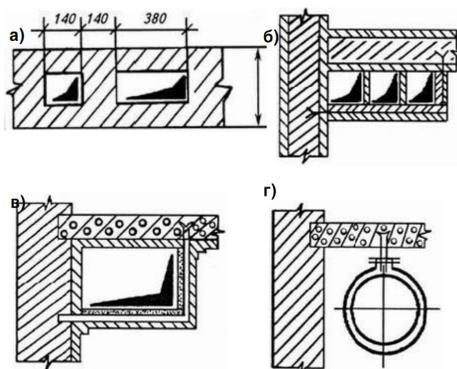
Воздуховоды: канал в стене (а); приставной вертикальный (б); подвесной горизонтальный (в); подвесной круглого сечения (г)
